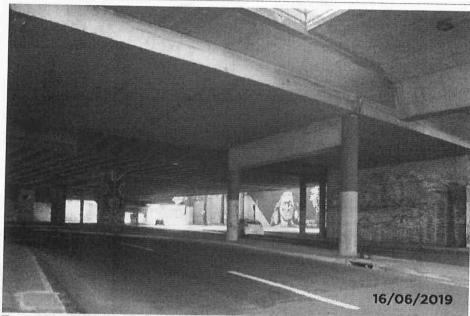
Vista da face inferior do tabuleiro com presença de infiltração, eflorescência, desplacamento de concreto, pilares sem proteção.
